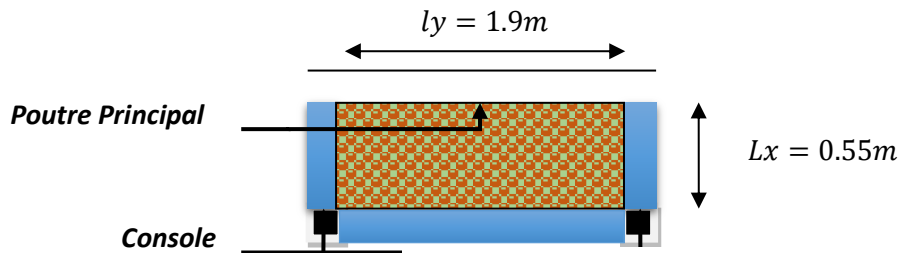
Schéma de ferrailage de la dalle poste transforme.
